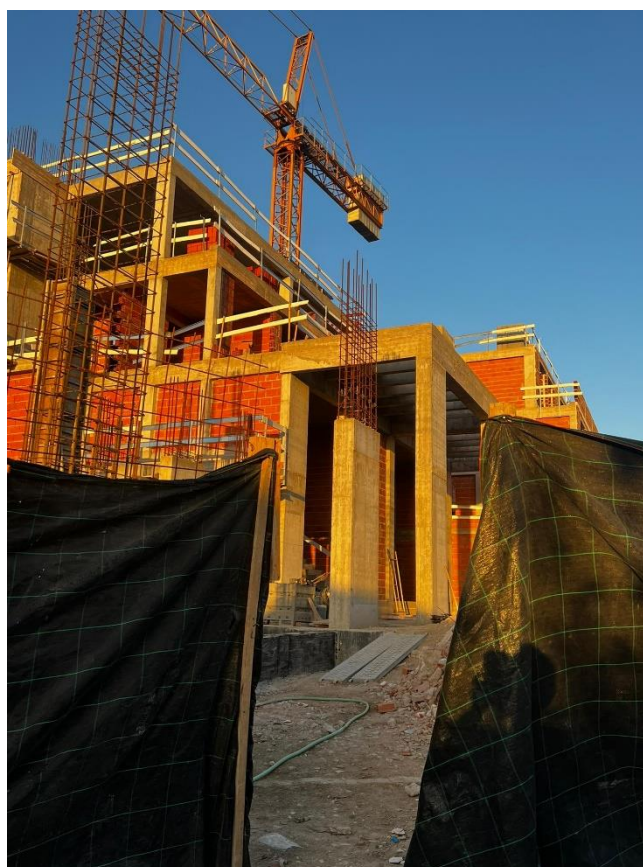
Vista Lateral da Construção Existente, com a expressão volumétrica da cave descoberta
